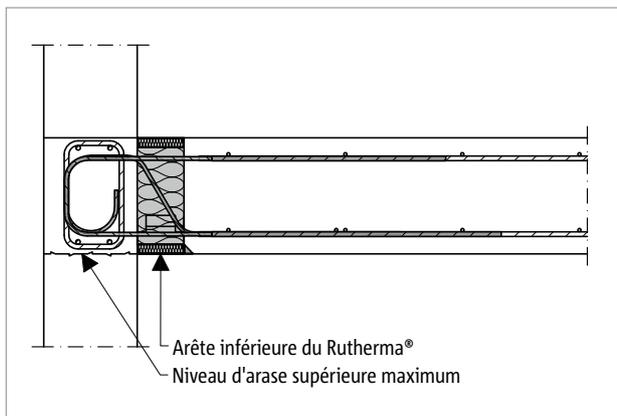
Schöck Rutherma® T type DFi : dalle en béton coulé sur place et façade en béton armé (valable également pour Schöck Rutherma® T type DFi-S)
